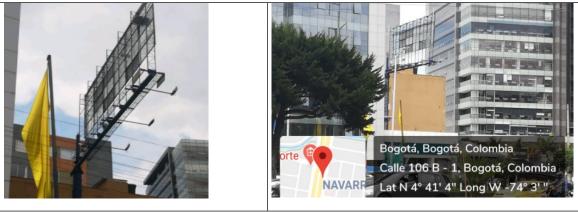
Detalle del tablero desmontado de la estructura de la valla ubicada en la Calle 108 N° 45 - 27 orientación Sur - Norte
